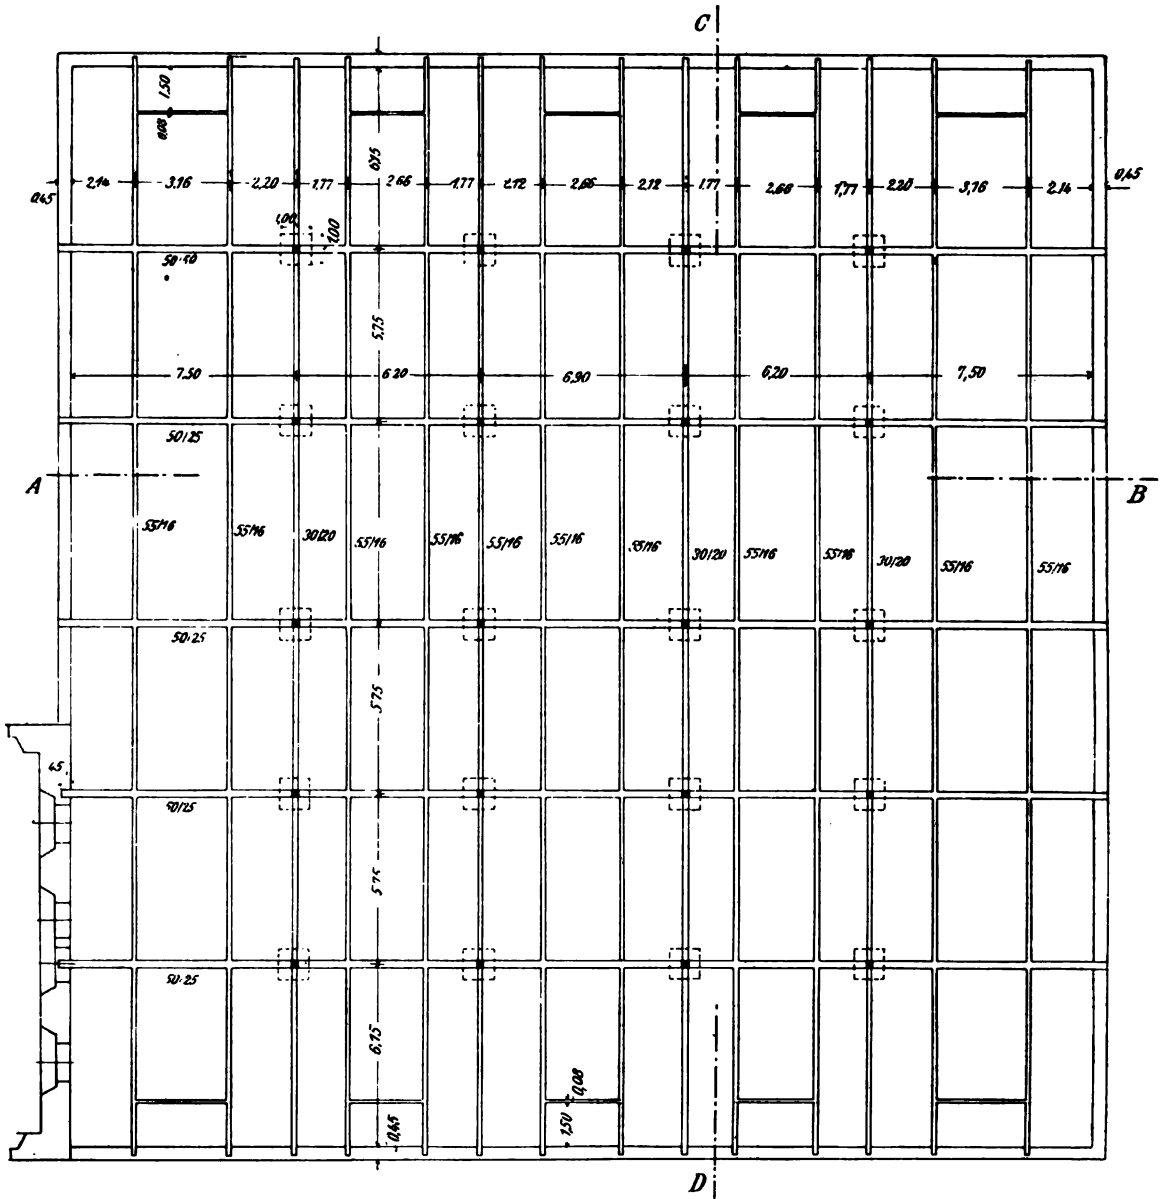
Grundriß der Fabrik Herzfeld u. Fischel in Hradsky.
